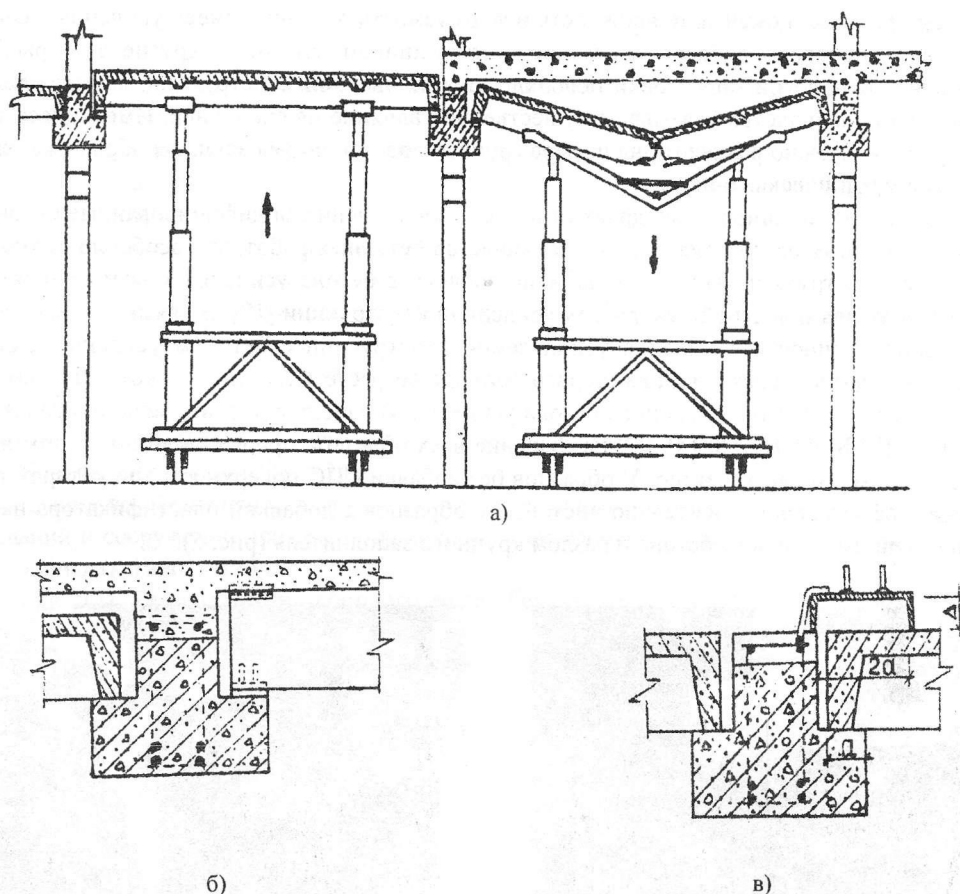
Способ замены сборного железобетонного перекрытия с использованием заменяющей конструкции в качестве съемной опалубки:
